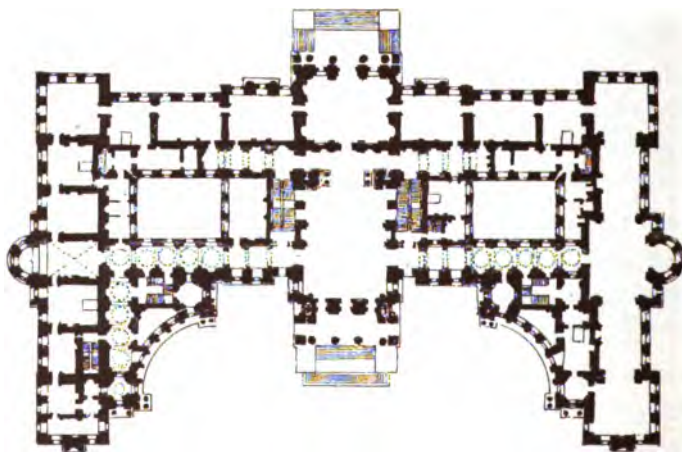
Grundriss von Schloss Blenheim (n. Fergusson).
